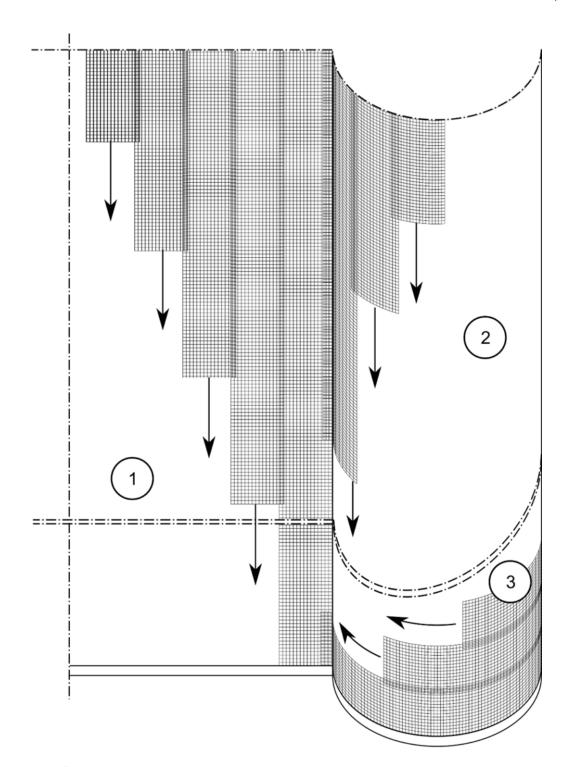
Harpage des panneaux au raccordement entre façade courbe et façade plane
